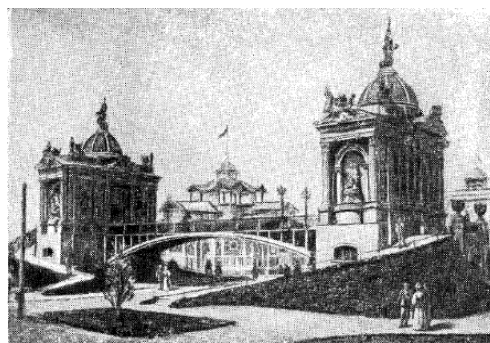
Железобетонный пешеходный арочный мостик пролетом 45 м на Нижегородской ярмарке
